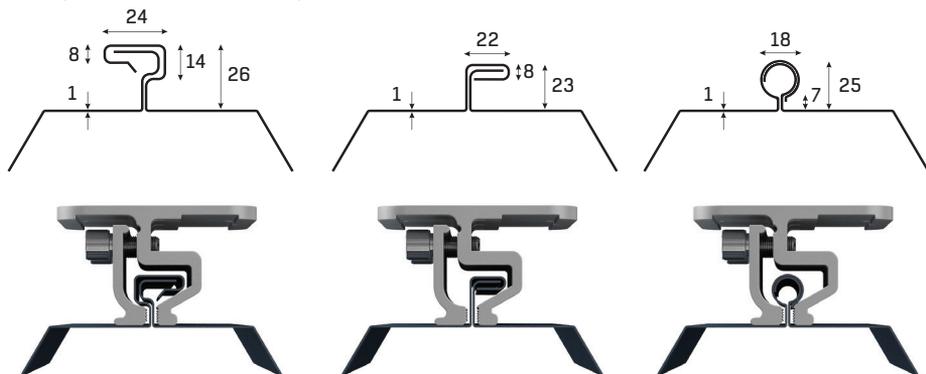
Способ крепления ФЭМ на фальцевую кровлю
